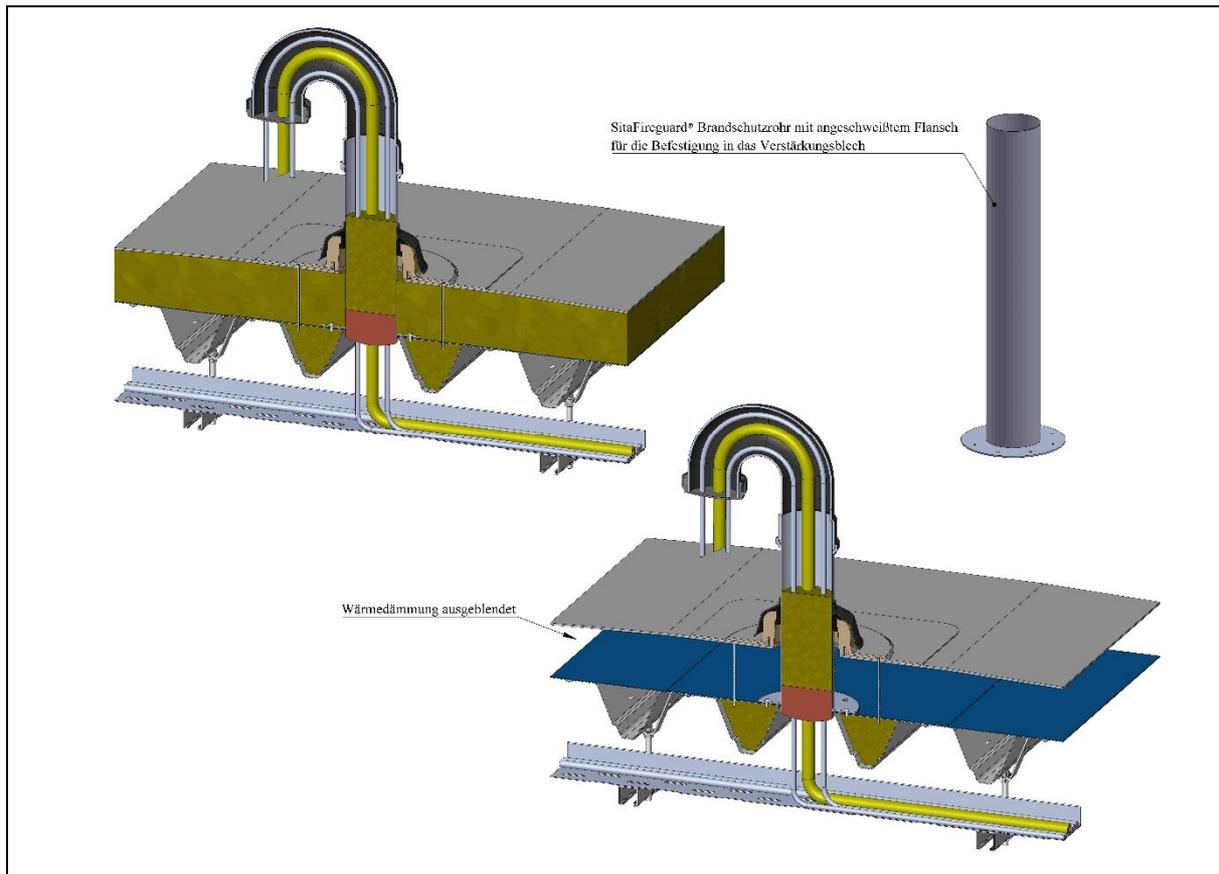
Einbaubeispiel des „SitaFireguard®“ Brandschutzrohr mit angeschweißtem Flansch für die Befestigung im Verstärkungsblech. Im unteren Bildteil eine Darstellung mit ausgeblendeter Wärmedämmung.
